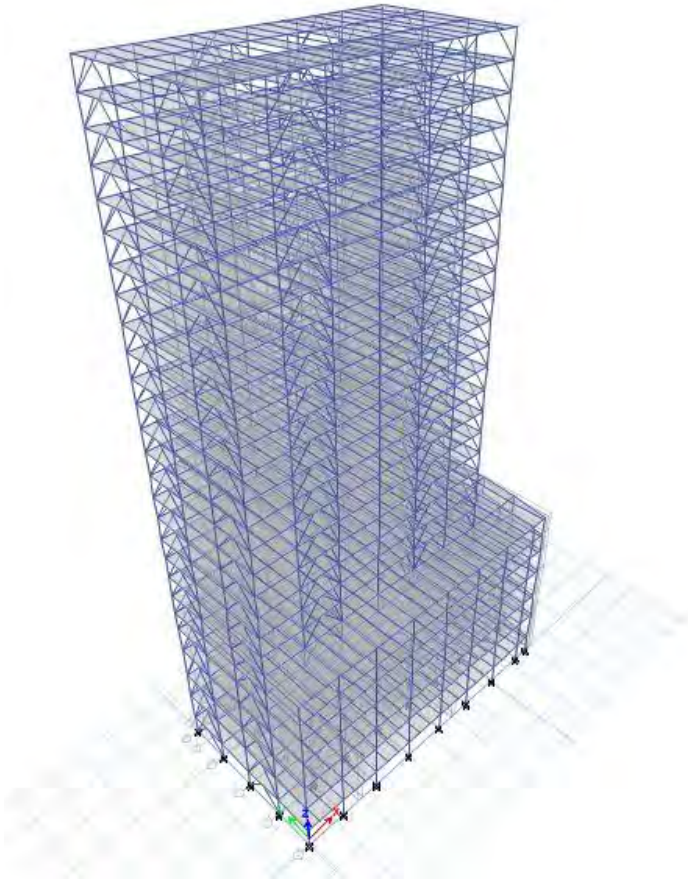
Denah Struktur Perkantoran One Galaxy
